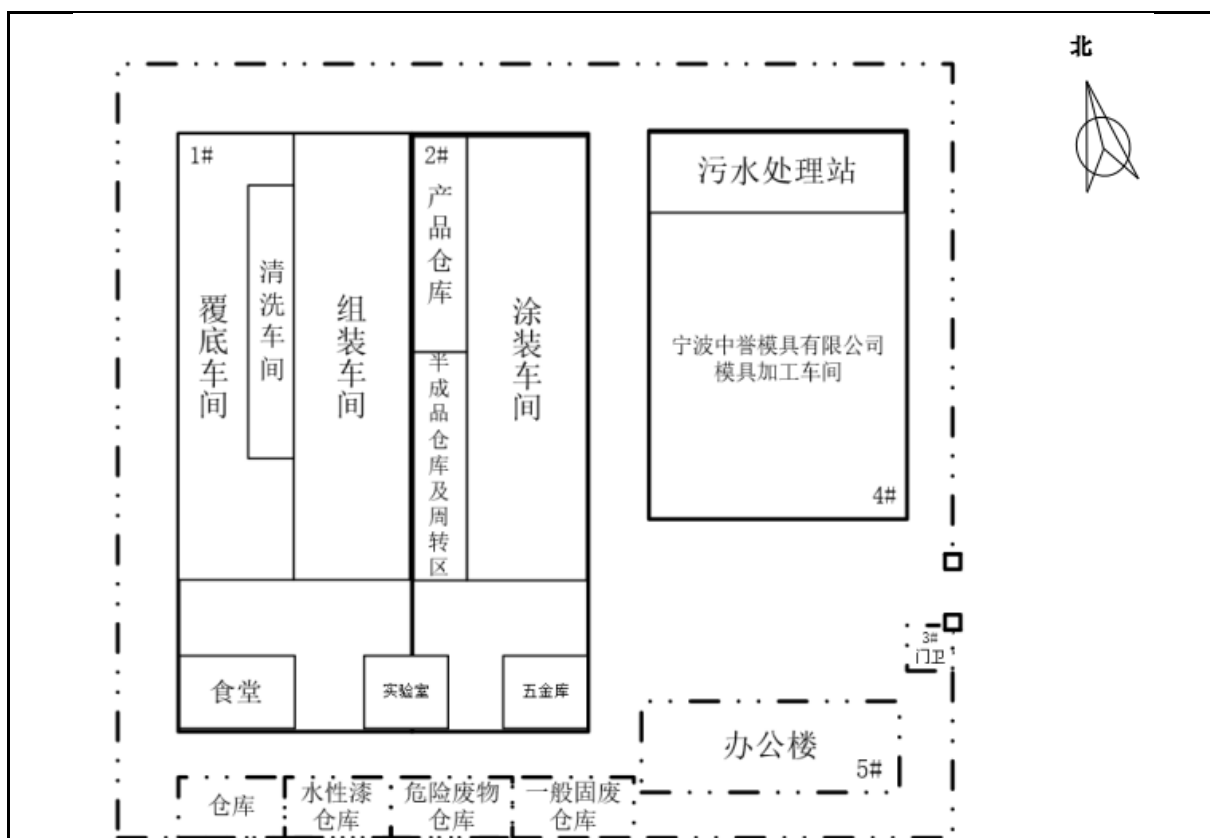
厂区总平面布置图（1#车间、2#车间、4#车间 1F）
